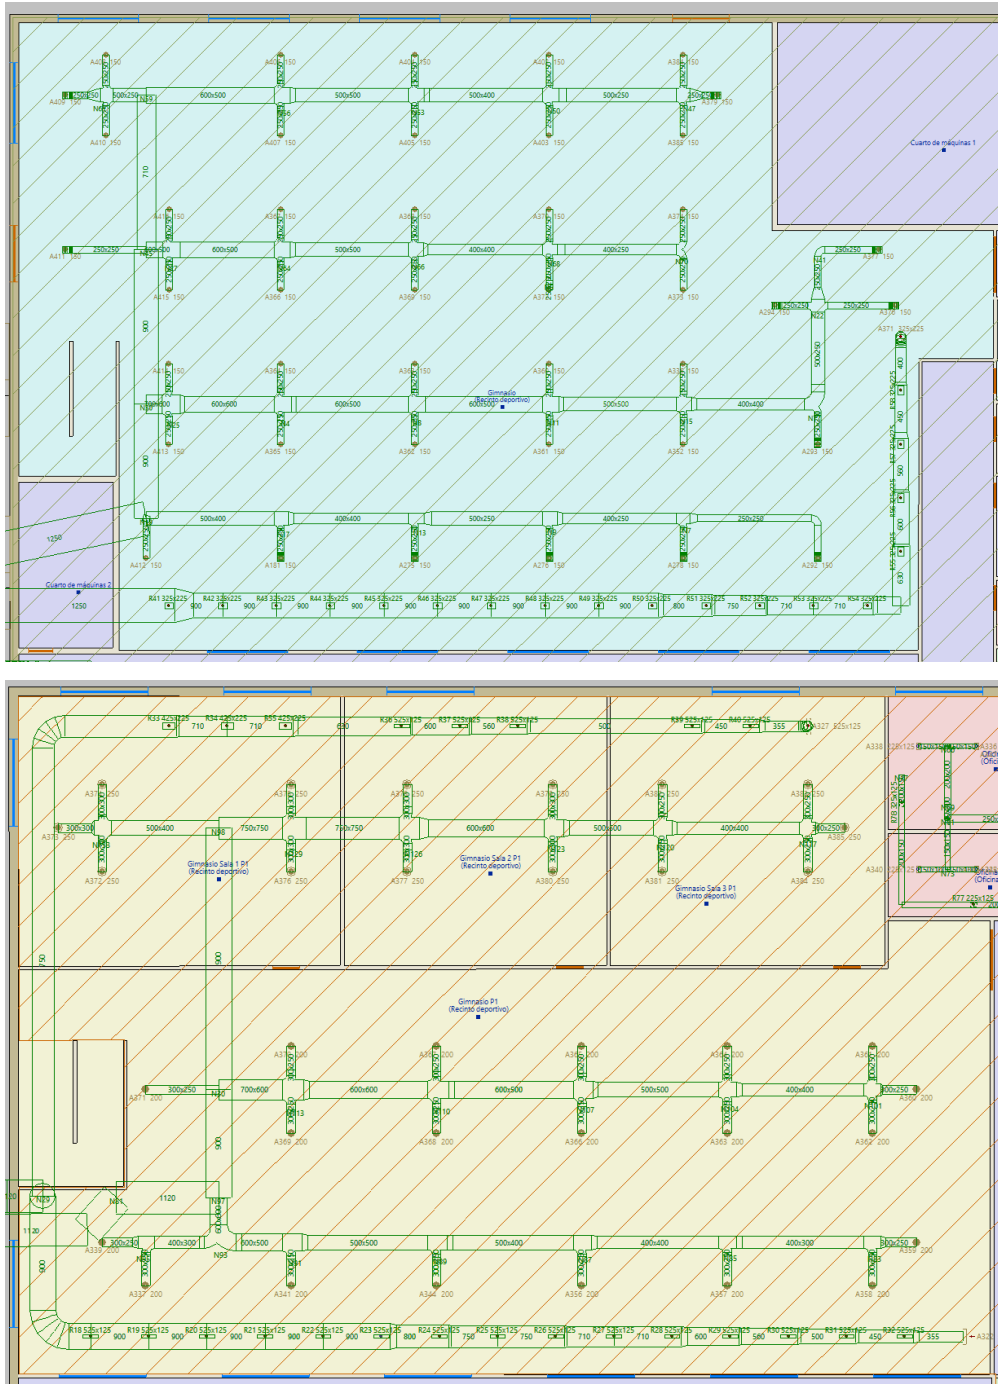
Distribución de conductos para climatización del gimnasio, en planta baja y planta primera, respectivamente.
